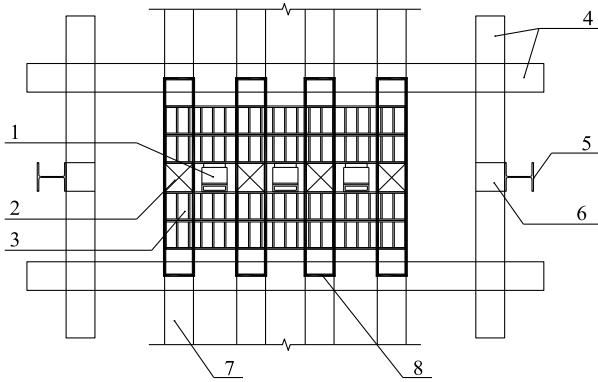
轴力伺服水平型钢组合支撑平面布置示意图
